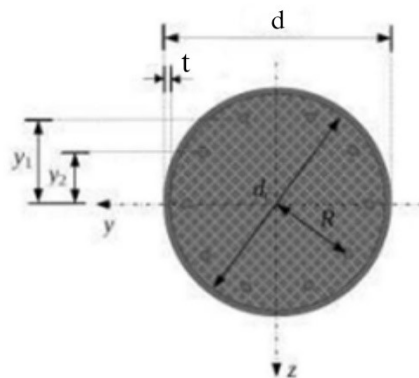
Конфигурация поперечного сечения колонны со схемой раскладки арматуры
